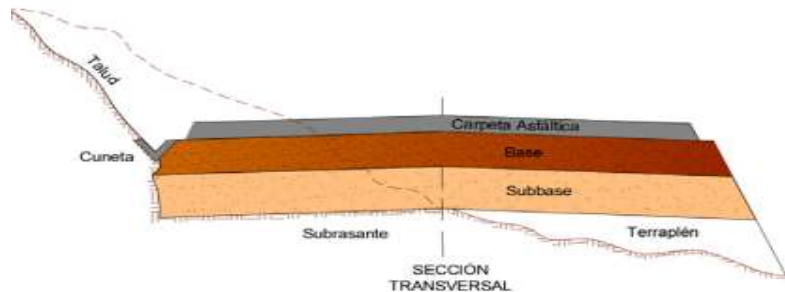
Componentes de típico de la estructura donde se muestra la sección del pavimento flexible.
